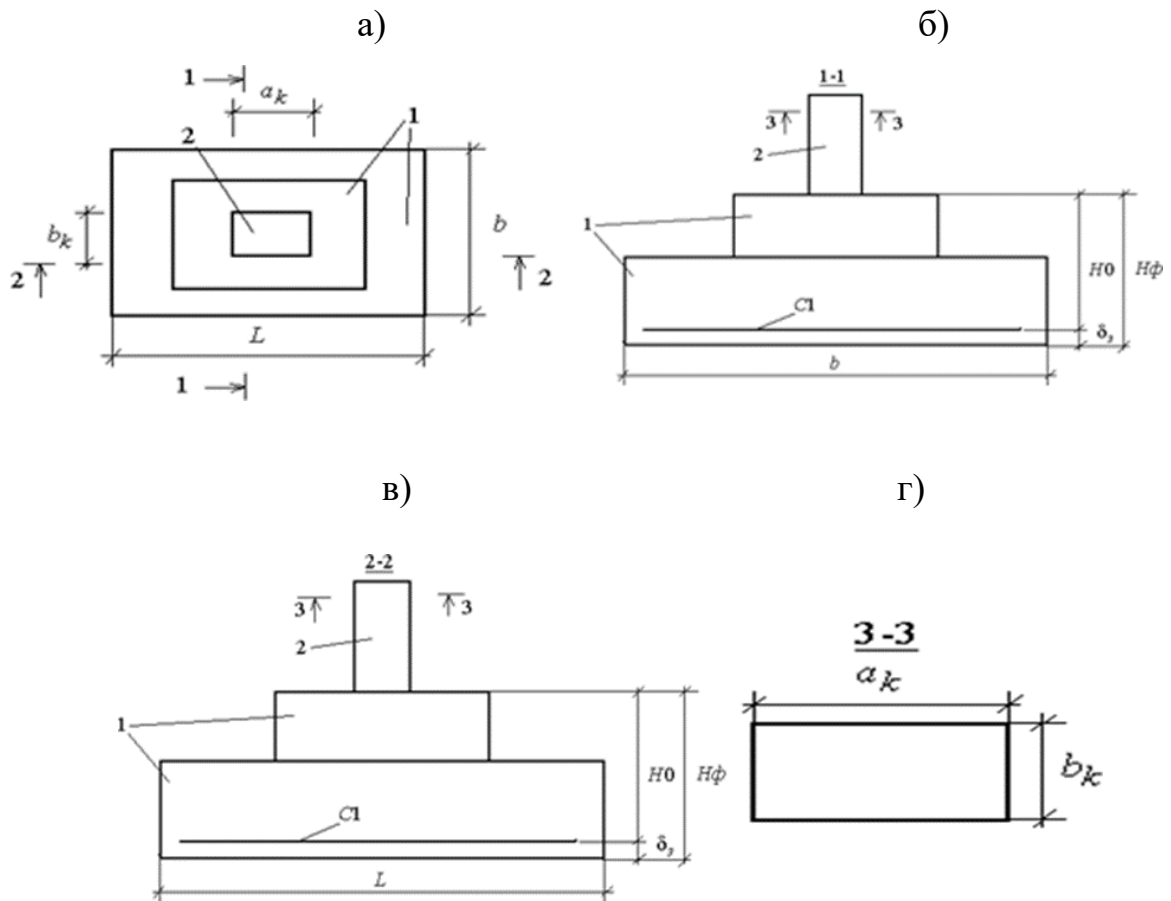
Схема до визначення товщини плитної частини фундаменту H_0 : а) план; б, в, г) розрізи; 1 – сходи фундаменту; 2- колона (або підколонник); C_1 – арматурна сітка; H_0 – товщина плитної частини фундаменту; δ_3 – товщина захисного шару фундаменту (її приймають в залежності від агресивності ґрунтових вод); H_ϕ – загальна товщина фундаменту
